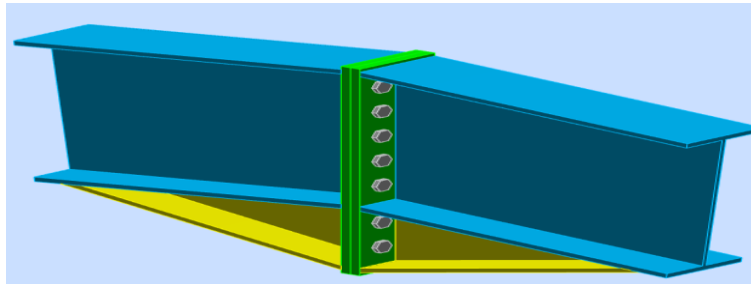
Vue 3D de l'assemblage au niveau de faîtage
